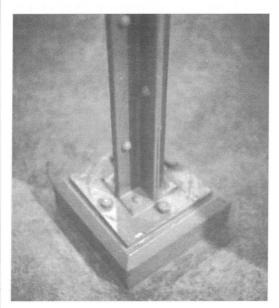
Sede para el Sindicato de Talladores de Diamantes. Pilares metálicos exentos en sala de planta segunda. Detalle.
